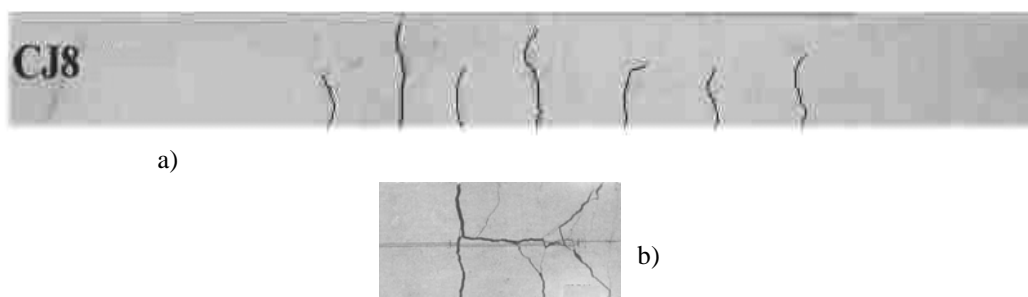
Viga *CJ8* – a) vista lateral – b) vista da ruptura de fundo.
